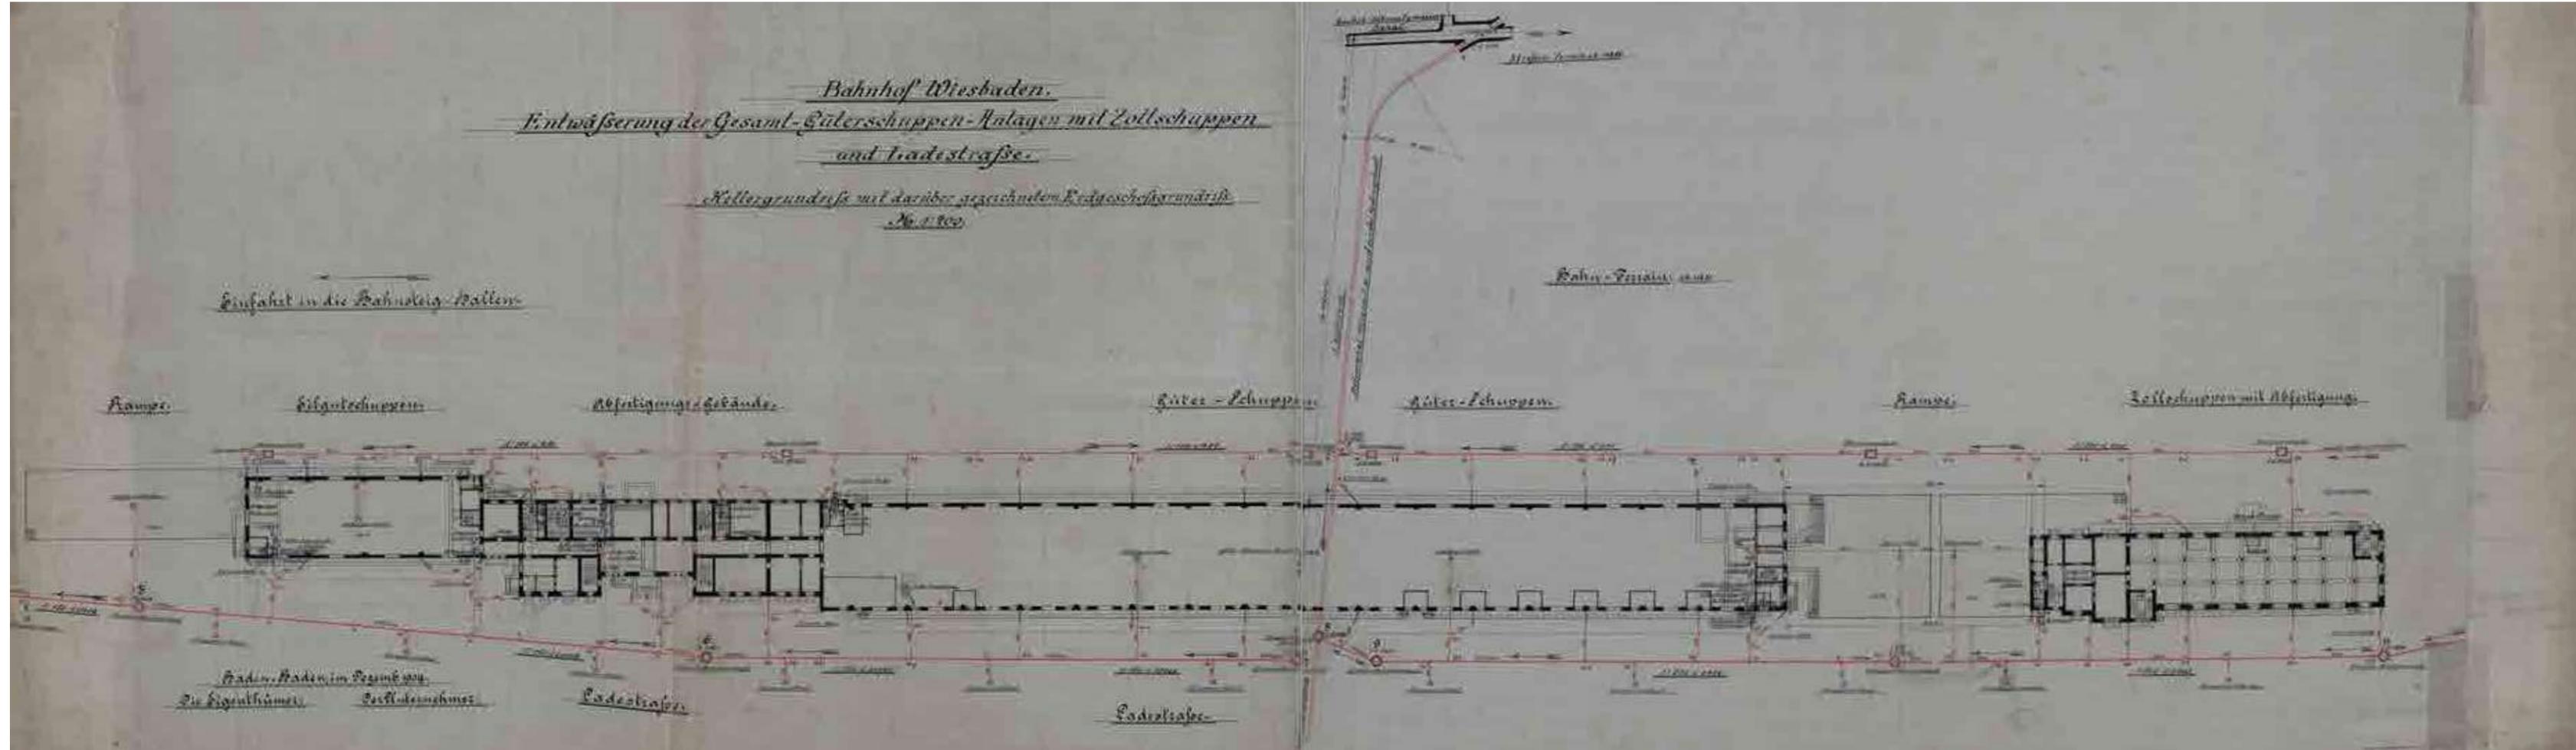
Gesamtanlage: Entwässerungsplan mit Erd- und Kellergeschoss (Grundriß teilweise so nicht ausgeführt), 1904
